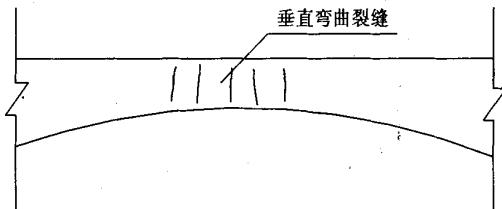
混凝土箱梁腹板弯曲裂缝
